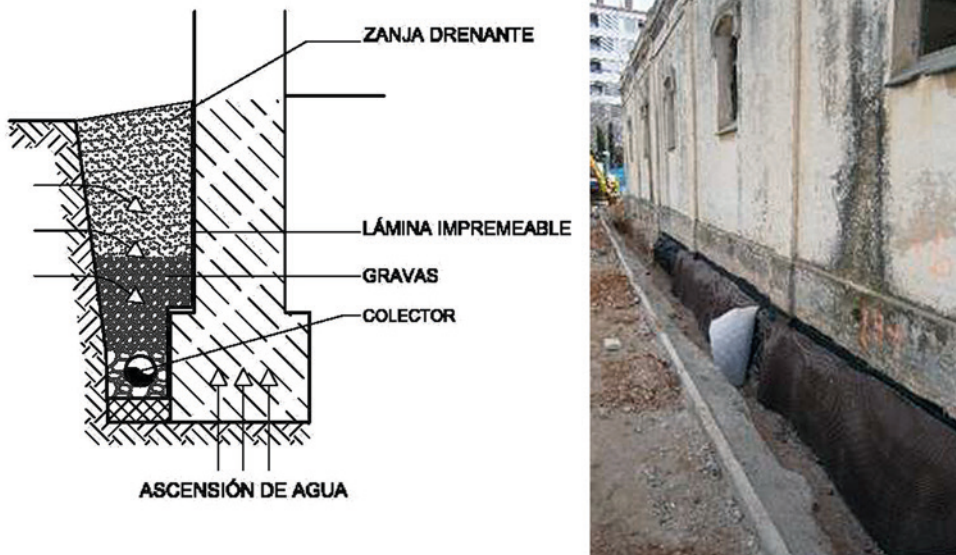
Esquema de drenaje dotado de tubo dren y zanja rellena con grava la parte inferior y con arena gruesa la superior. En la foto, ejemplo de zanja de drenaje con membrana impermeable recubriendo el muro en contacto con el relleno de la zanja.
